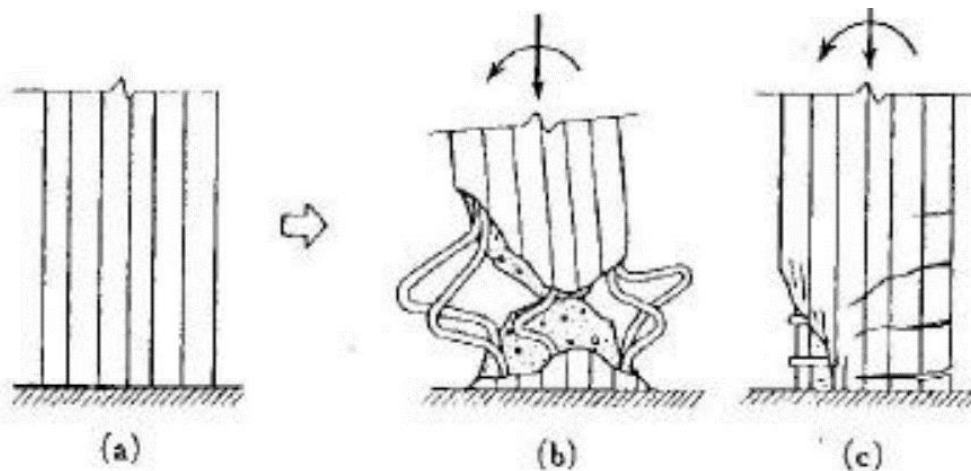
Falla de columna de concreto armado debido a la acción de fuerzas sísmicas y gravitacionales. Fuente: *Retrofitting Design of Building Structures*, Xilin Lu (2010).
